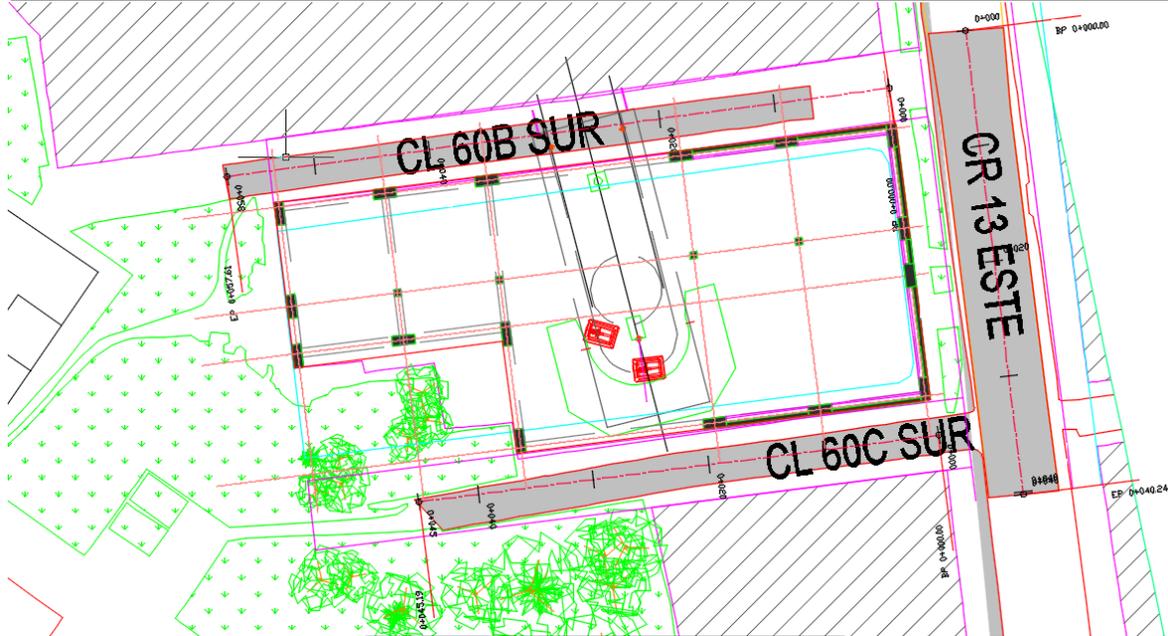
Planta estación retorno Juan Rey (Alternativa 3)
